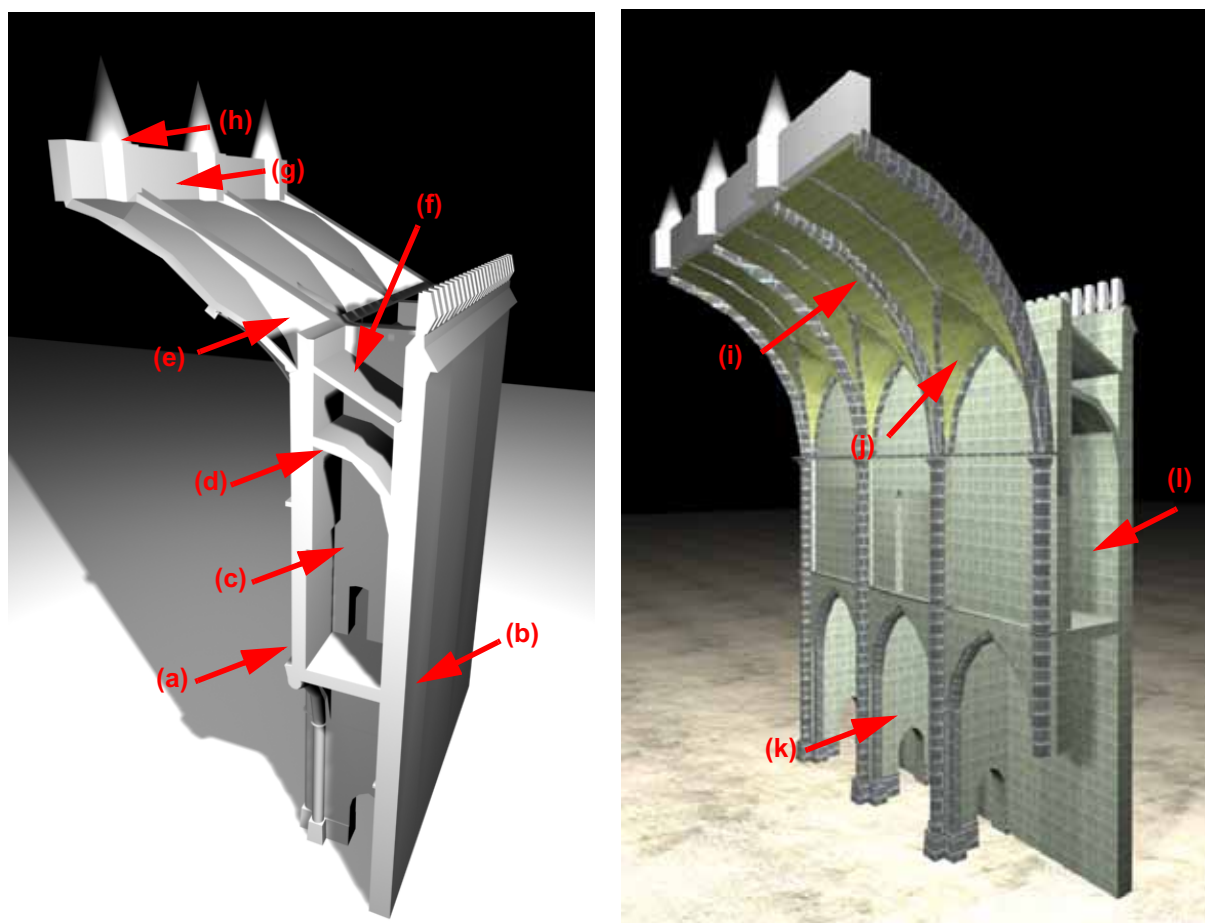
Esquema dos encontros da abóbada da nave: a) parede longitudinal interior; b) parede longitudinal exterior; c) contraforte/parede transversal; d) abóbada botante; e) muro de carga dos arcos principais; f) terraço lateral; g) muro de remate da cumeeira; h) coruchéu; i) arco principal ou mestre; j) luneta; k) capela lateral; l) galeria sobre capelas laterais.
